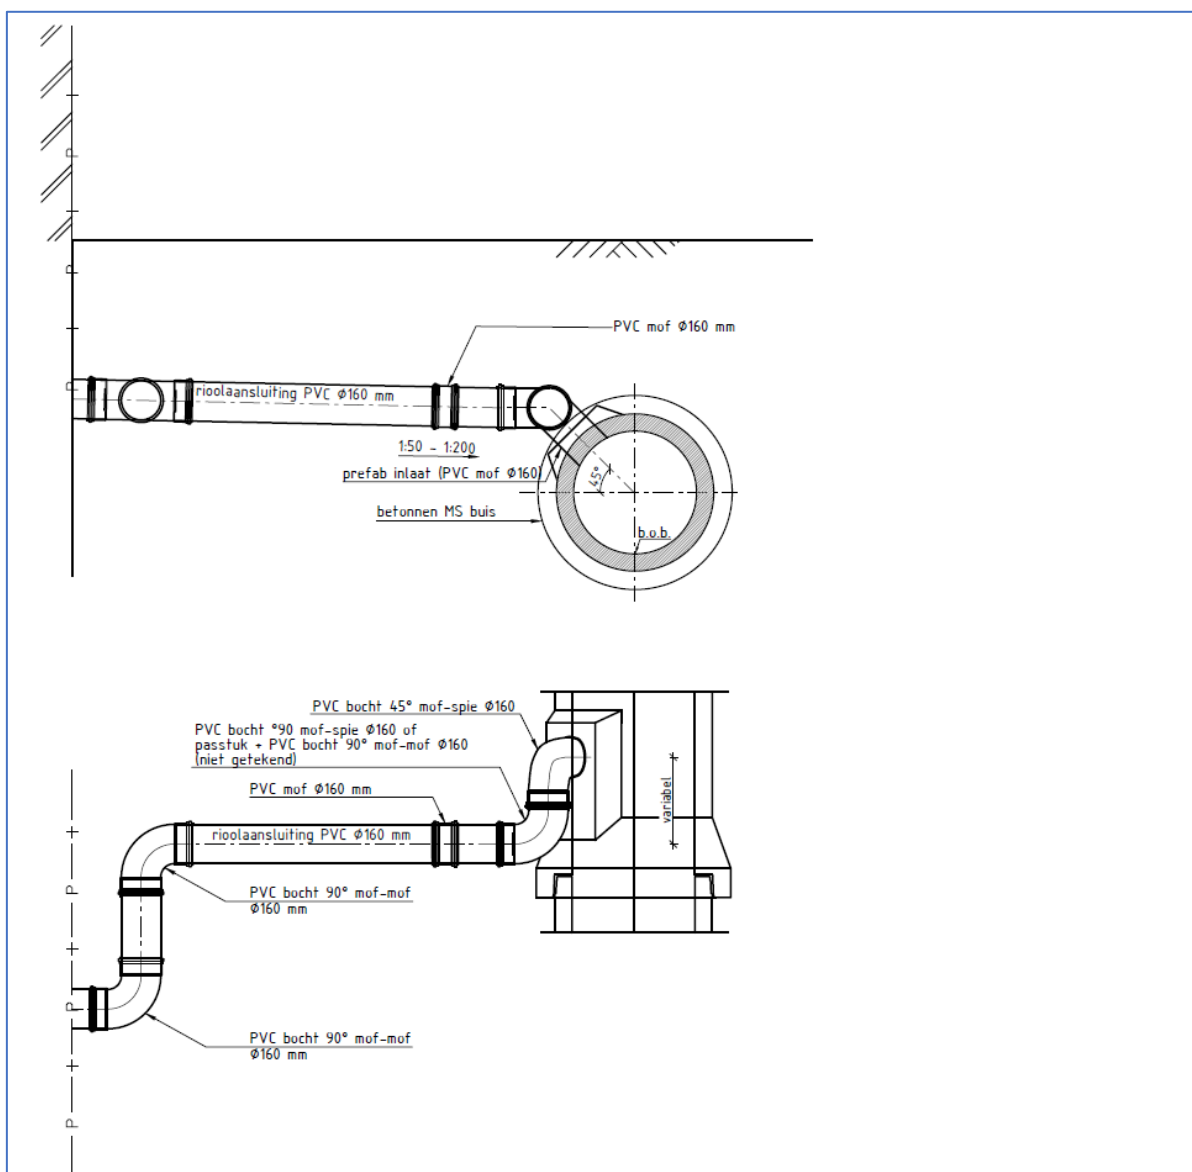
Bovenaansluiting met PVC Stroom T-Stuk op Ms Buizen (Alleen Voor Twee Kolkaansluitingen)
